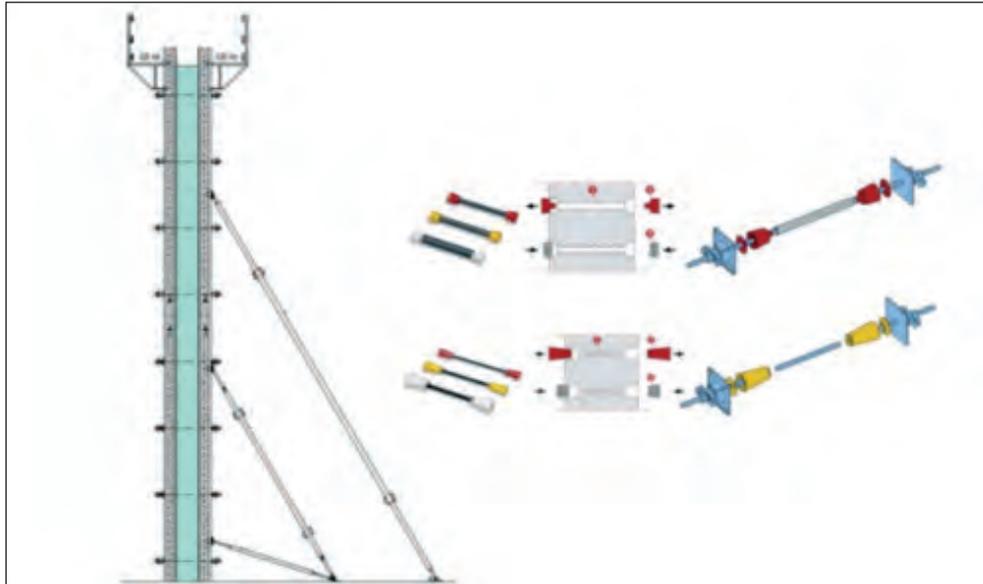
Esquema de encofrado a dos caras y barras de anclaje
